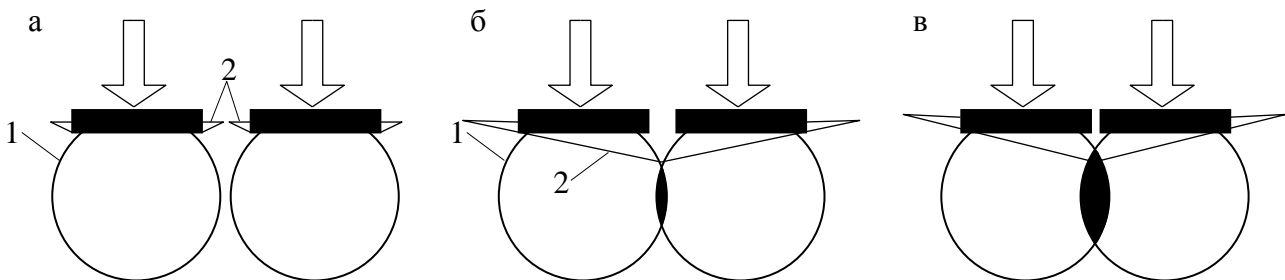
Взаємний вплив двох фундаментів: а – зони напружень не перекриваються; б, в – зони напружень перекриваються; 1 – зона напружень; 2 – вирва осідання
